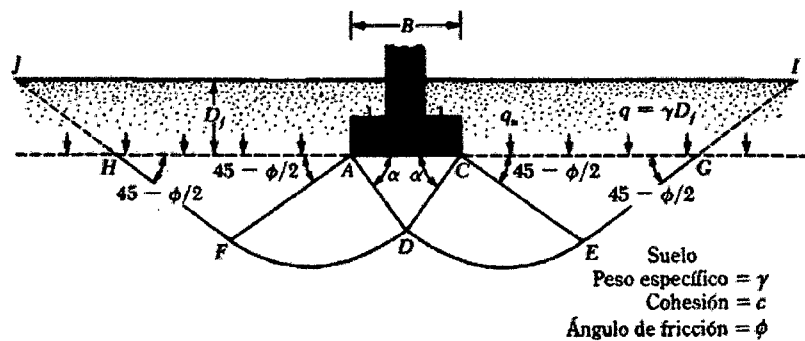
Falla por capacidad de carga en suelo bajo una cimentación rígida corrida.
